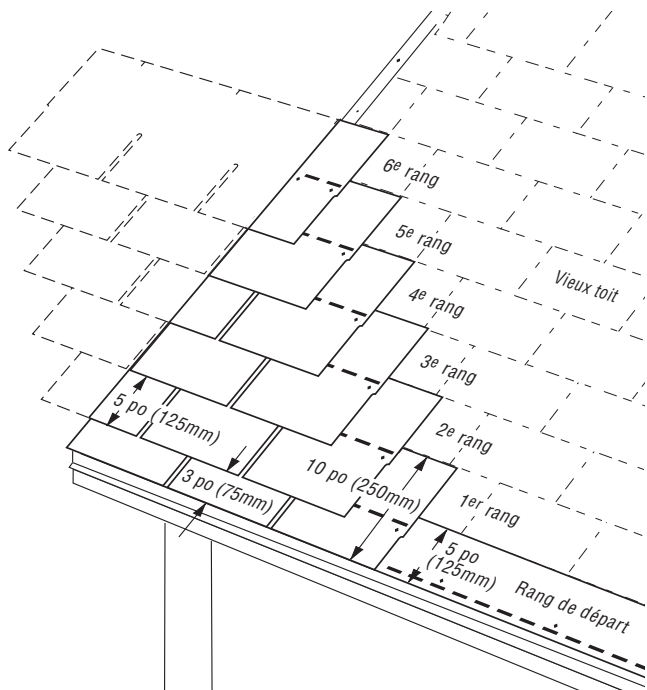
Six en diagonale, six à la verticale, imbriqué.
